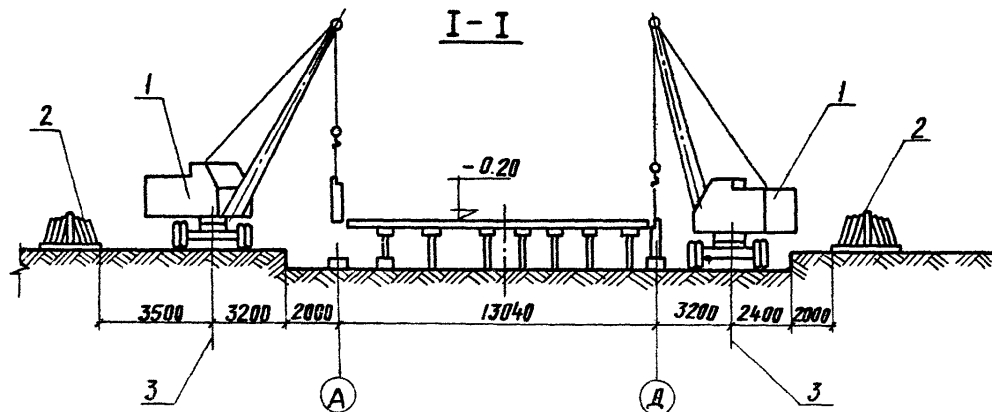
Монтаж поперечных панелей: 1-пневмоколёсный кран К-161;
